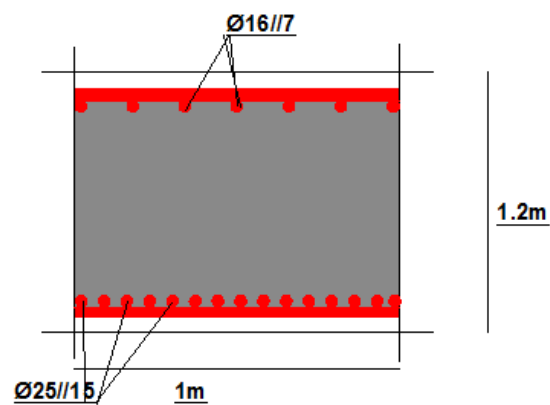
Schéma de ferrailage à mis travée dans la direction transversale(Coupe A-A)
